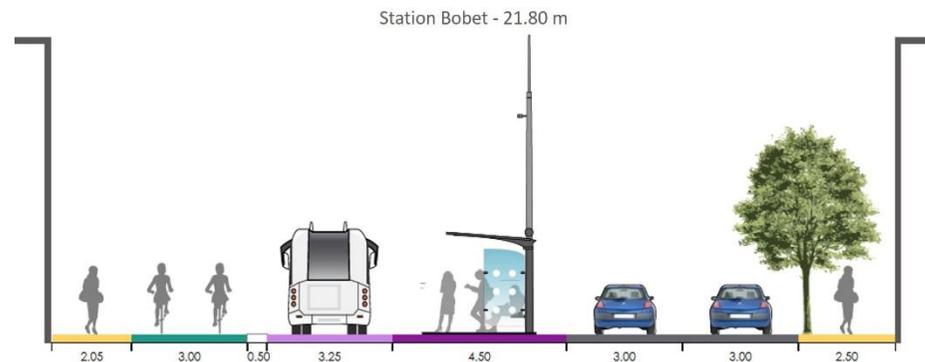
Coupe 1B-2 - projet de la station Bobet
